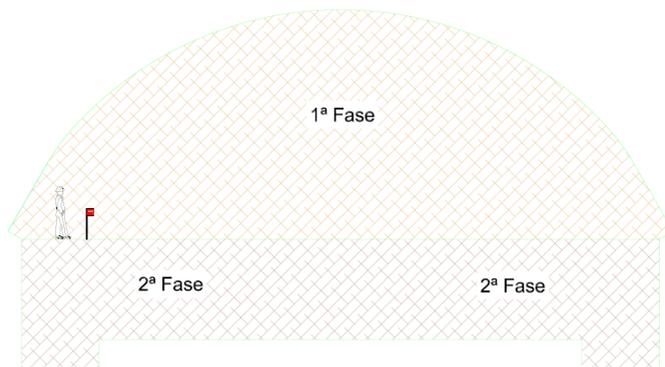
Faseamento da escavação geral ZG1 / ZG2 (Fonte: Consórcio)
